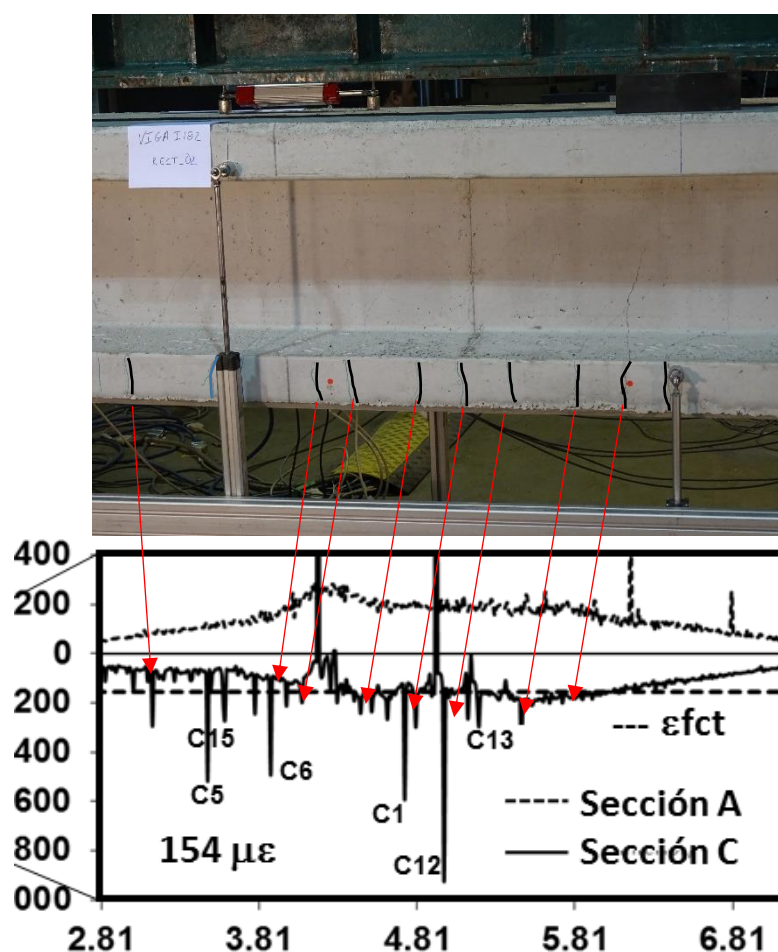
Estado de deformaciones en ensayo a flexión de la viga I-3 a 125 kN
